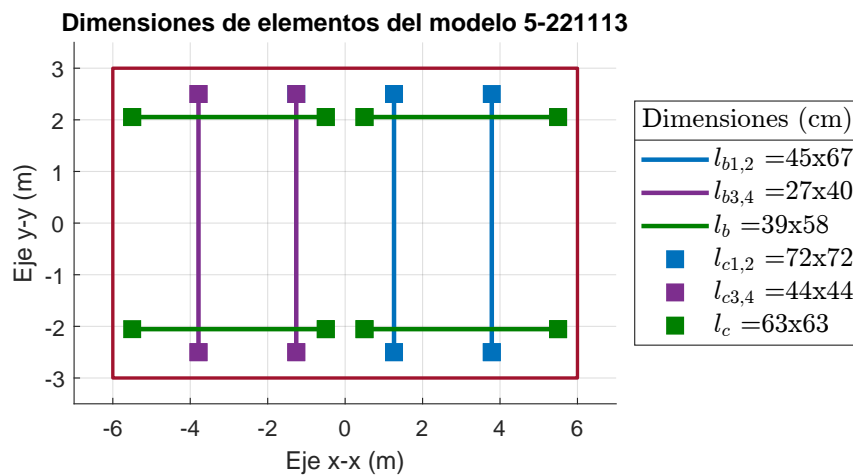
Esquema en planta de las dimensiones de vigas y columnas para el modelo 5-221113.
